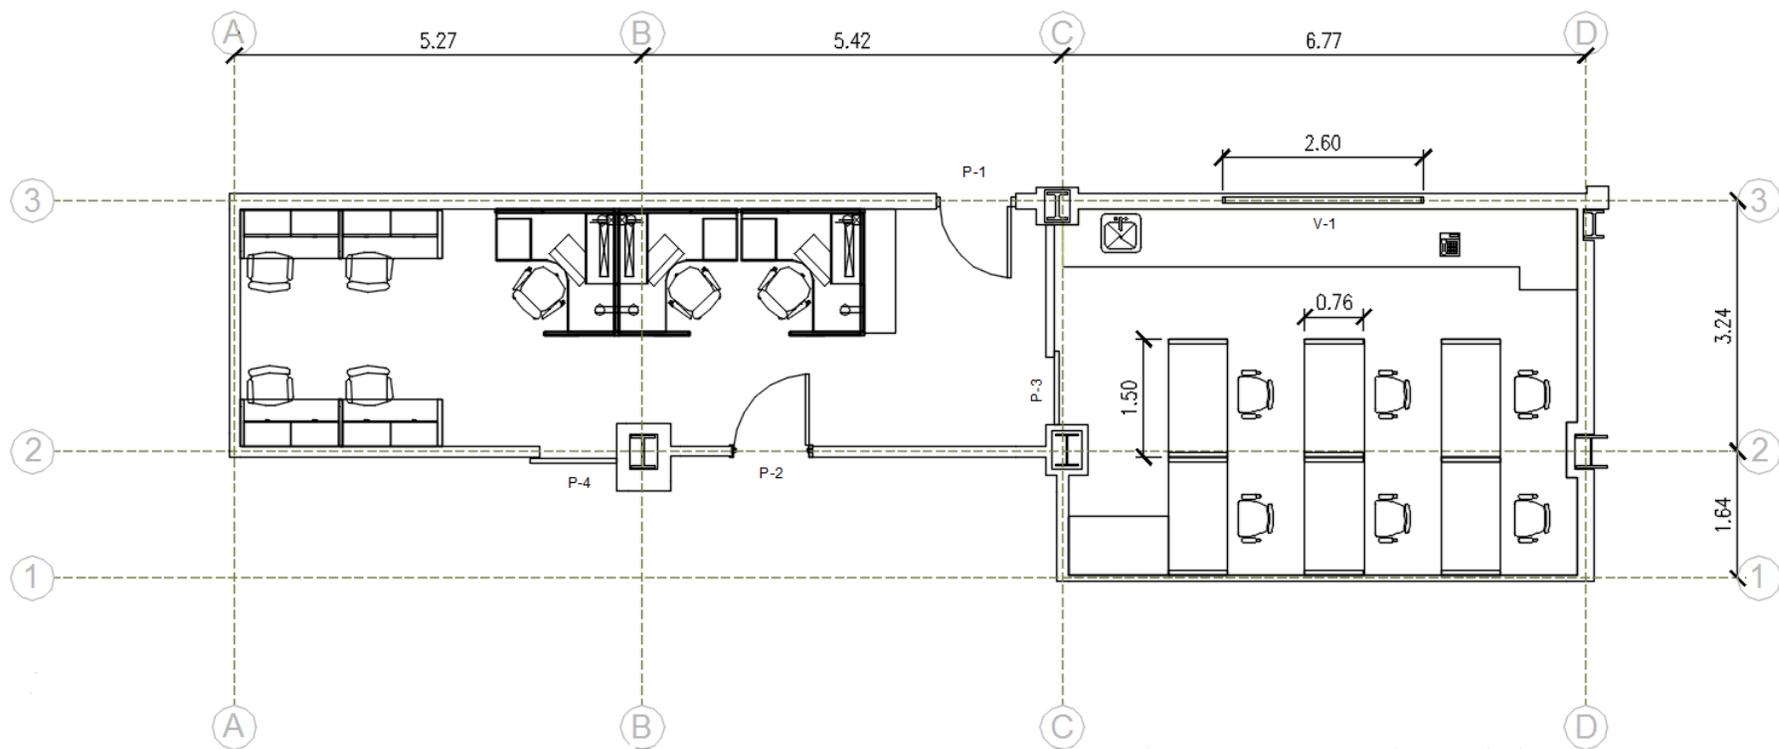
Distribución de planta del laboratorio y área administrativa al detalle.
